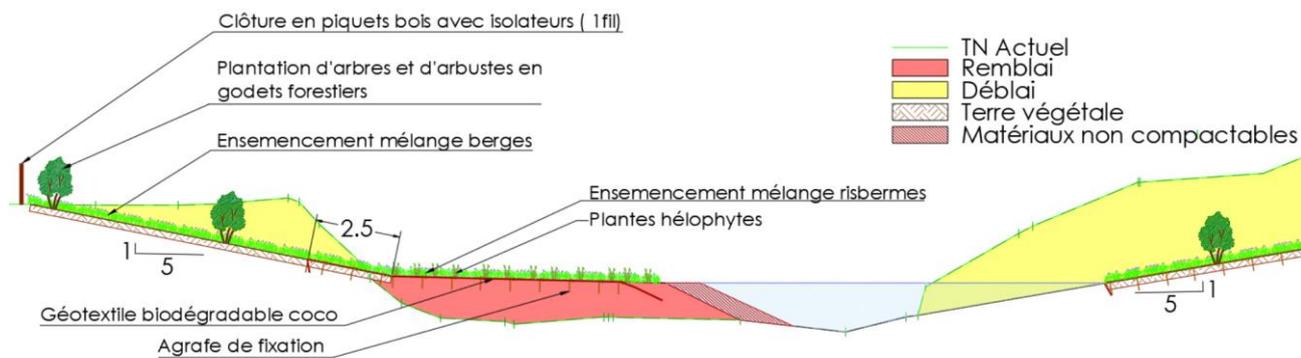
Coupe type de l'aménagement : plantations et mise en place d'un géotextile sur la risberme et la partie inférieure de la berge
